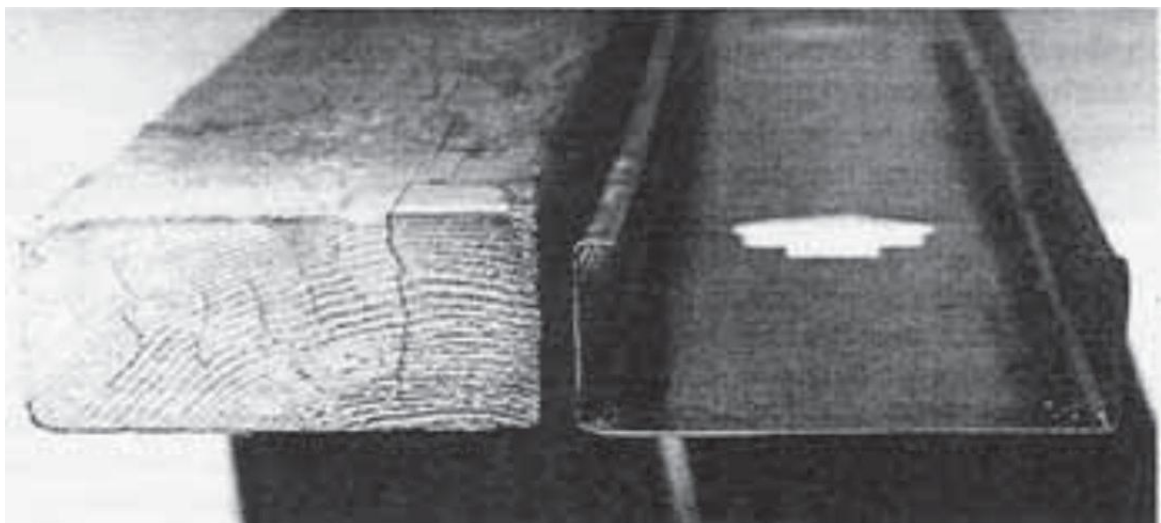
Perfis estruturais de madeira e aço galvanizado.
